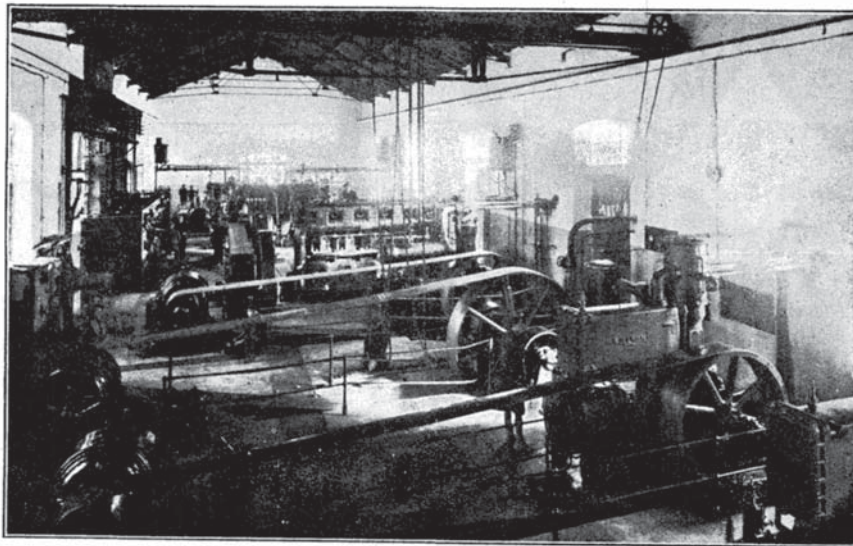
Interno della sala macchine del cantiere dei pozzi. Diesel elettrici di riserva e compressori a bassa tensione per la perforazione.
